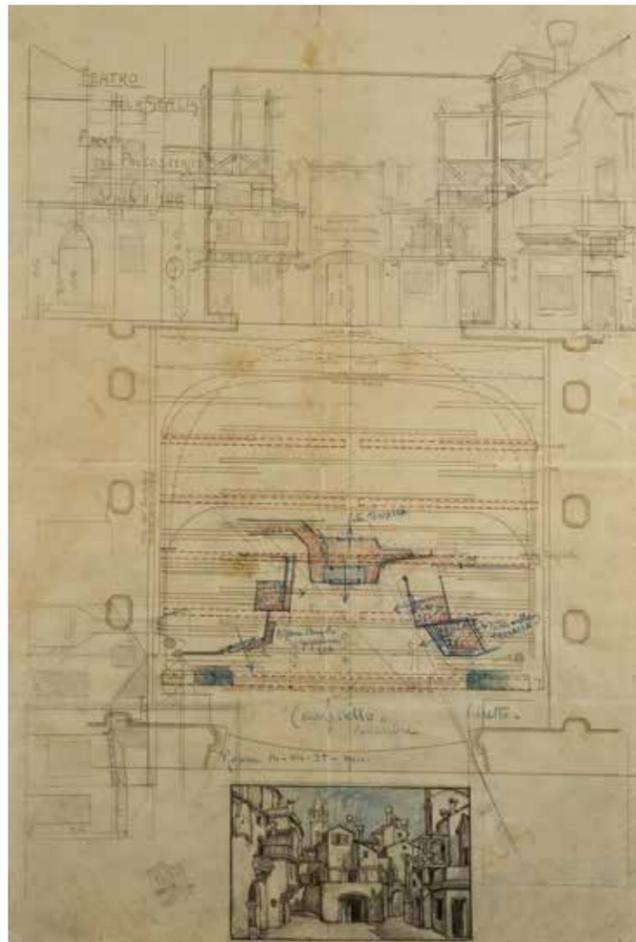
Studio per *Il Campiello*, pianta e prospetto, 1935. Milano, collezione privata.
